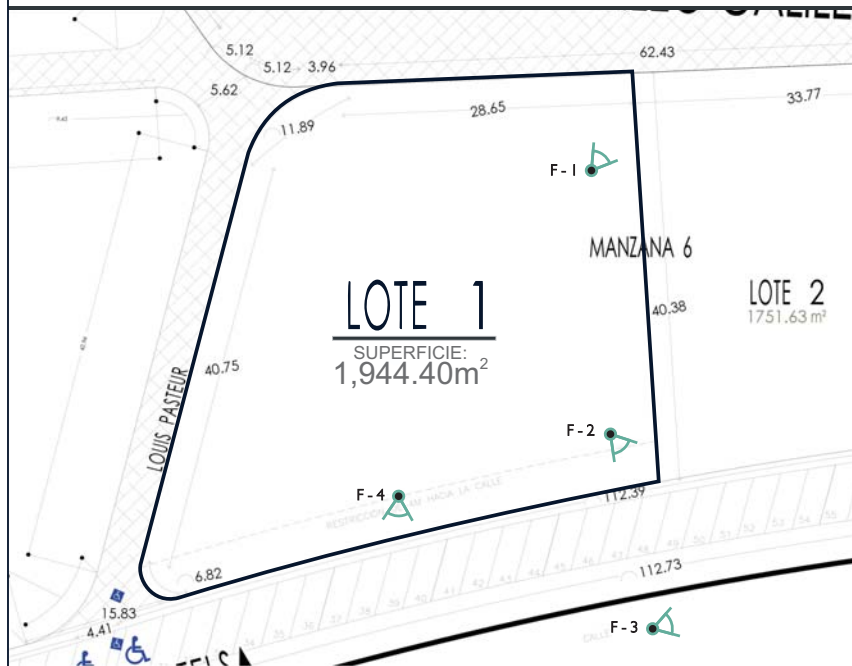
Lote de Quantum donde se plantea el proyecto IZATA.
